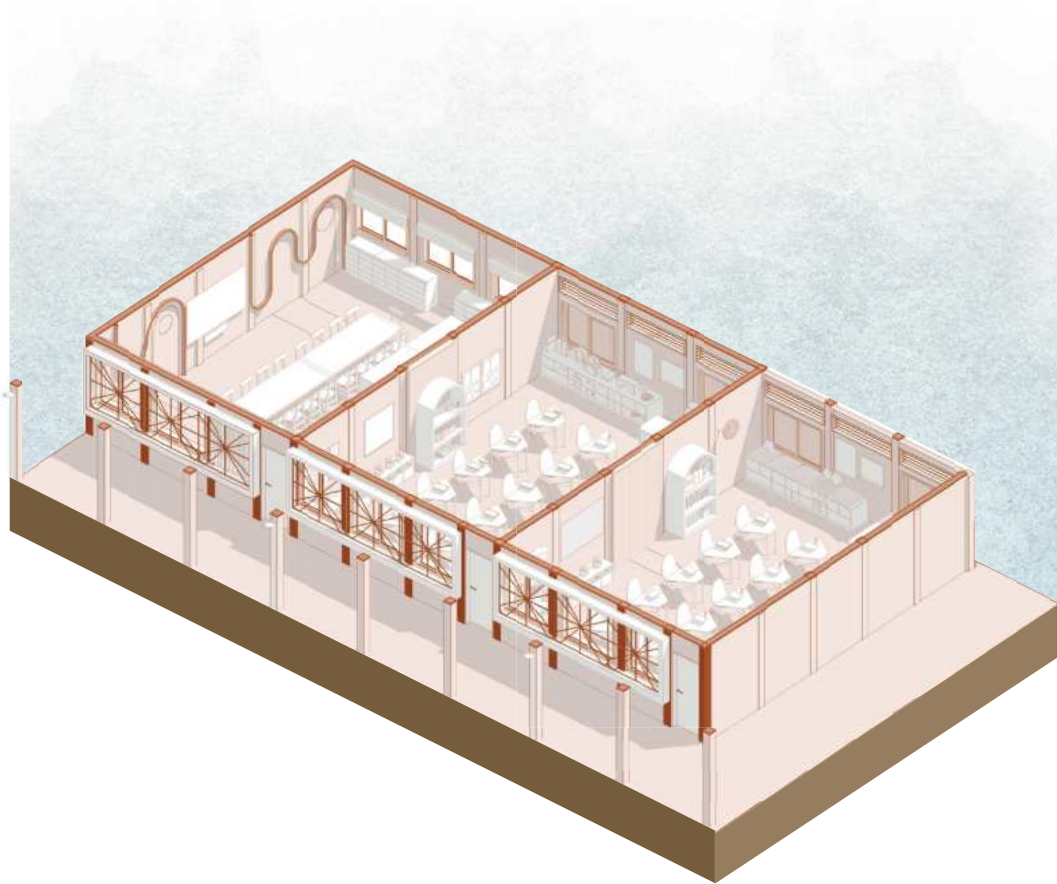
Planta arquitectónica de Sala de juntas y Aulas 1 y 2 | Fuente: Elaboración propia
